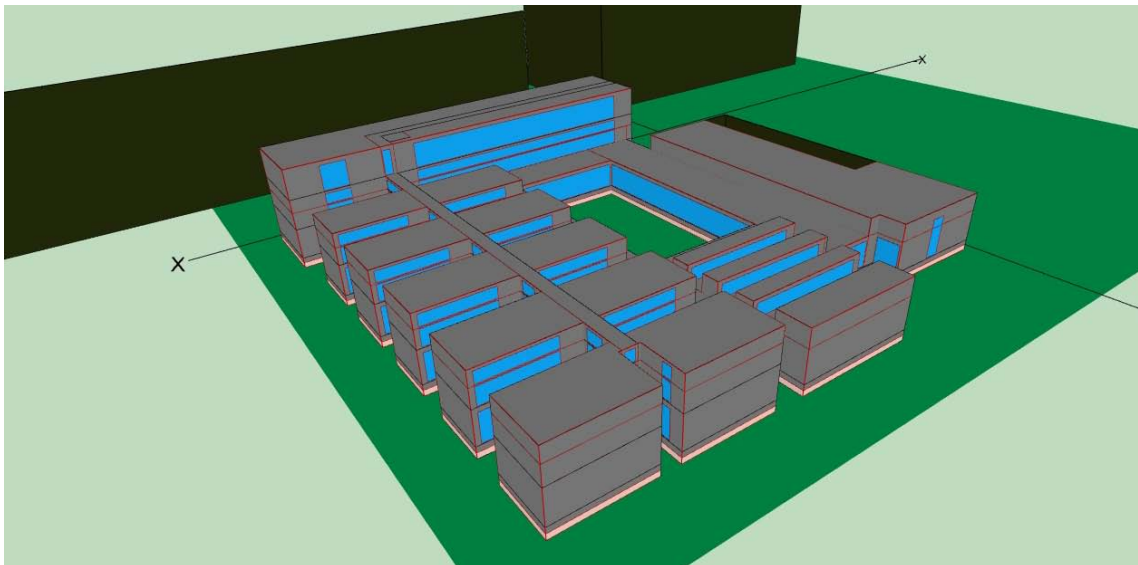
Edificio terminado. Vista Nor-este. Las sombras del fondo son edificios de viviendas existentes al sur.
